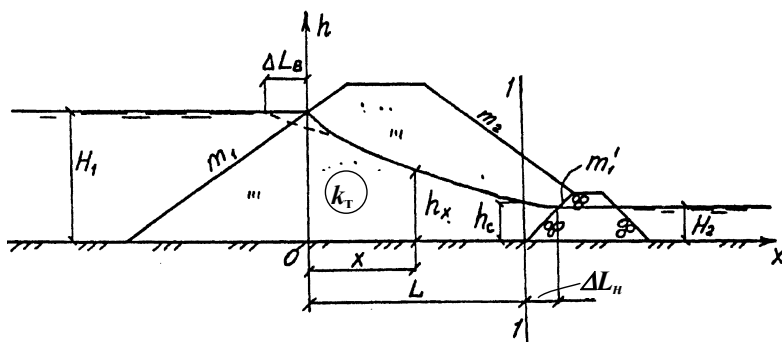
Схема к расчету фильтрации однородной грунтовой плотины с дренажным банкетом на водонепроницаемом основании
